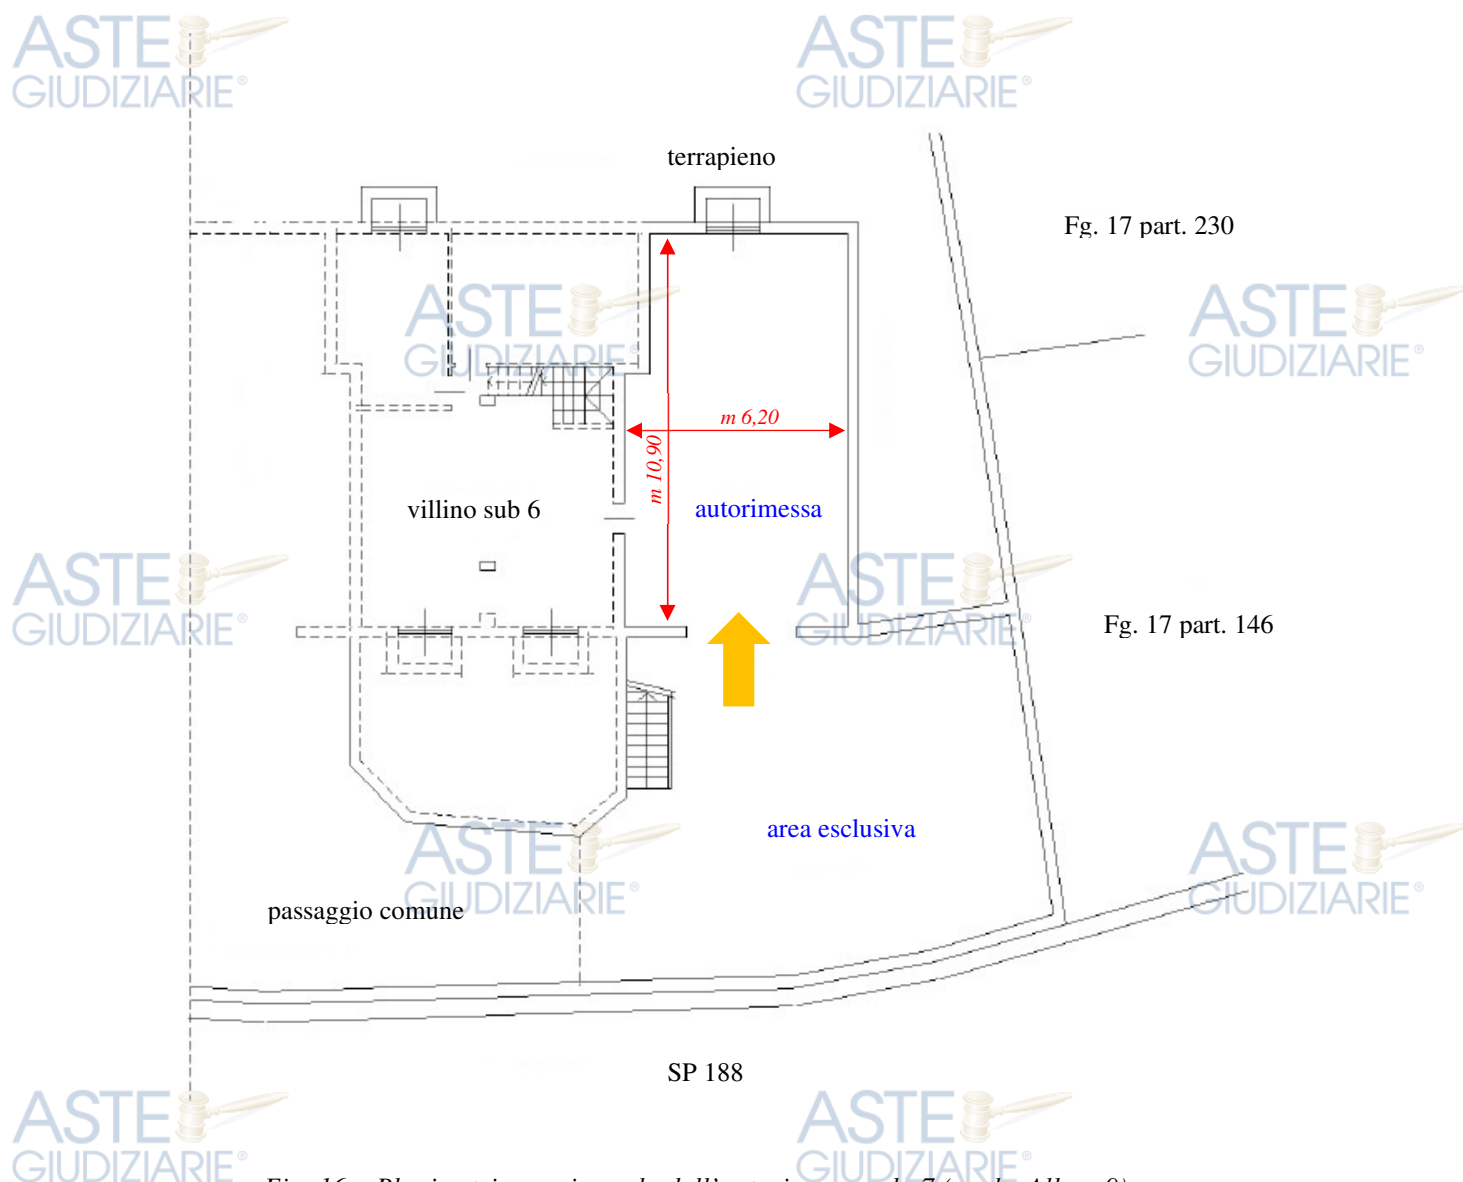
Planimetria non in scala dell'autorimessa sub. 7 (anche All. n. 9)
